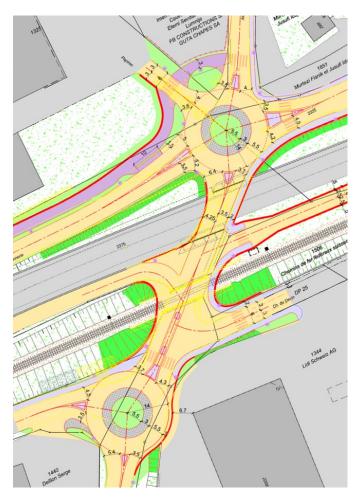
les deux giratoires, ainsi que les 3 ouvrages (PS 601, PICFF, rampe)
